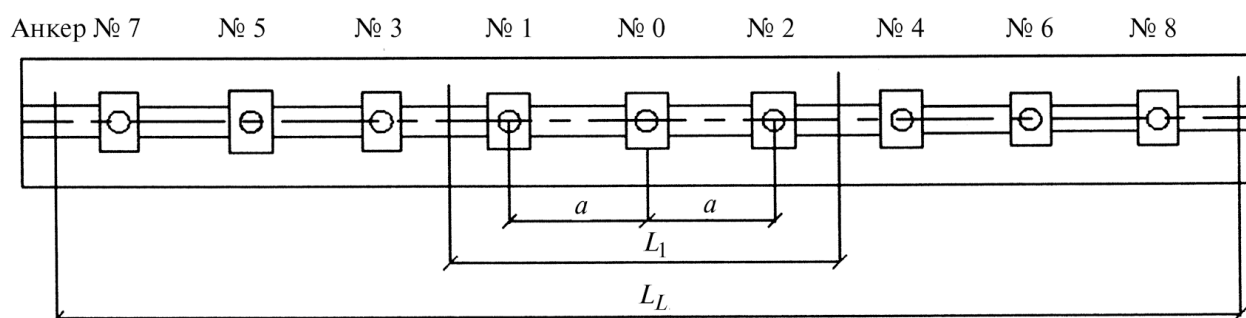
Схема расположения анкеров на продольном поясе (анкер № 0 – отказ при испытании)
